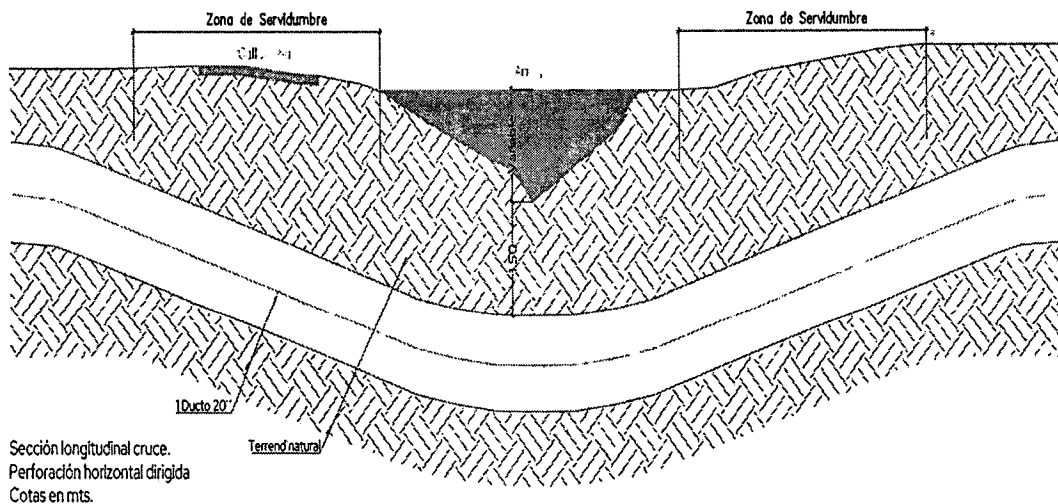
Detalle sección longitudinal Fuente: RODAS SOLAR S.A.S, 2025
